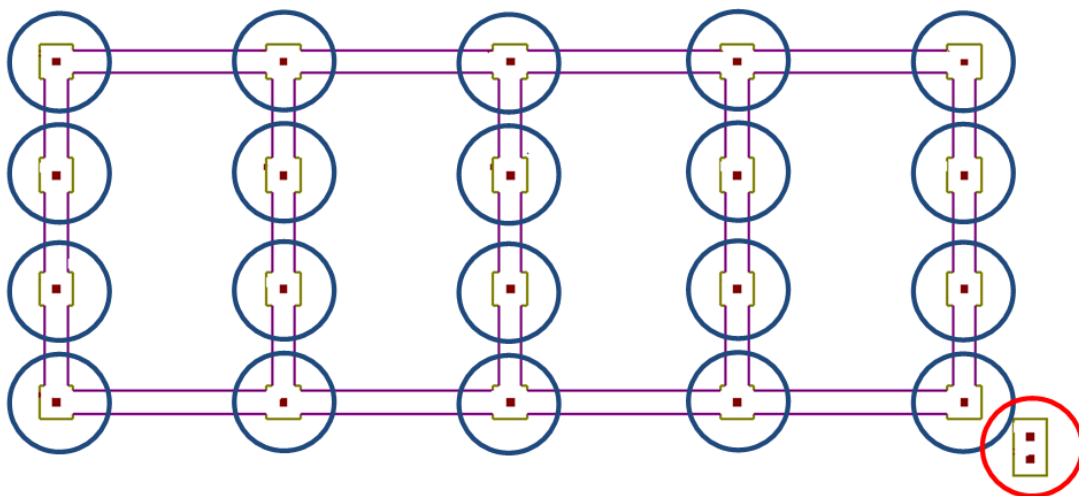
Vista de las cimentaciones del silo y de la escalera
